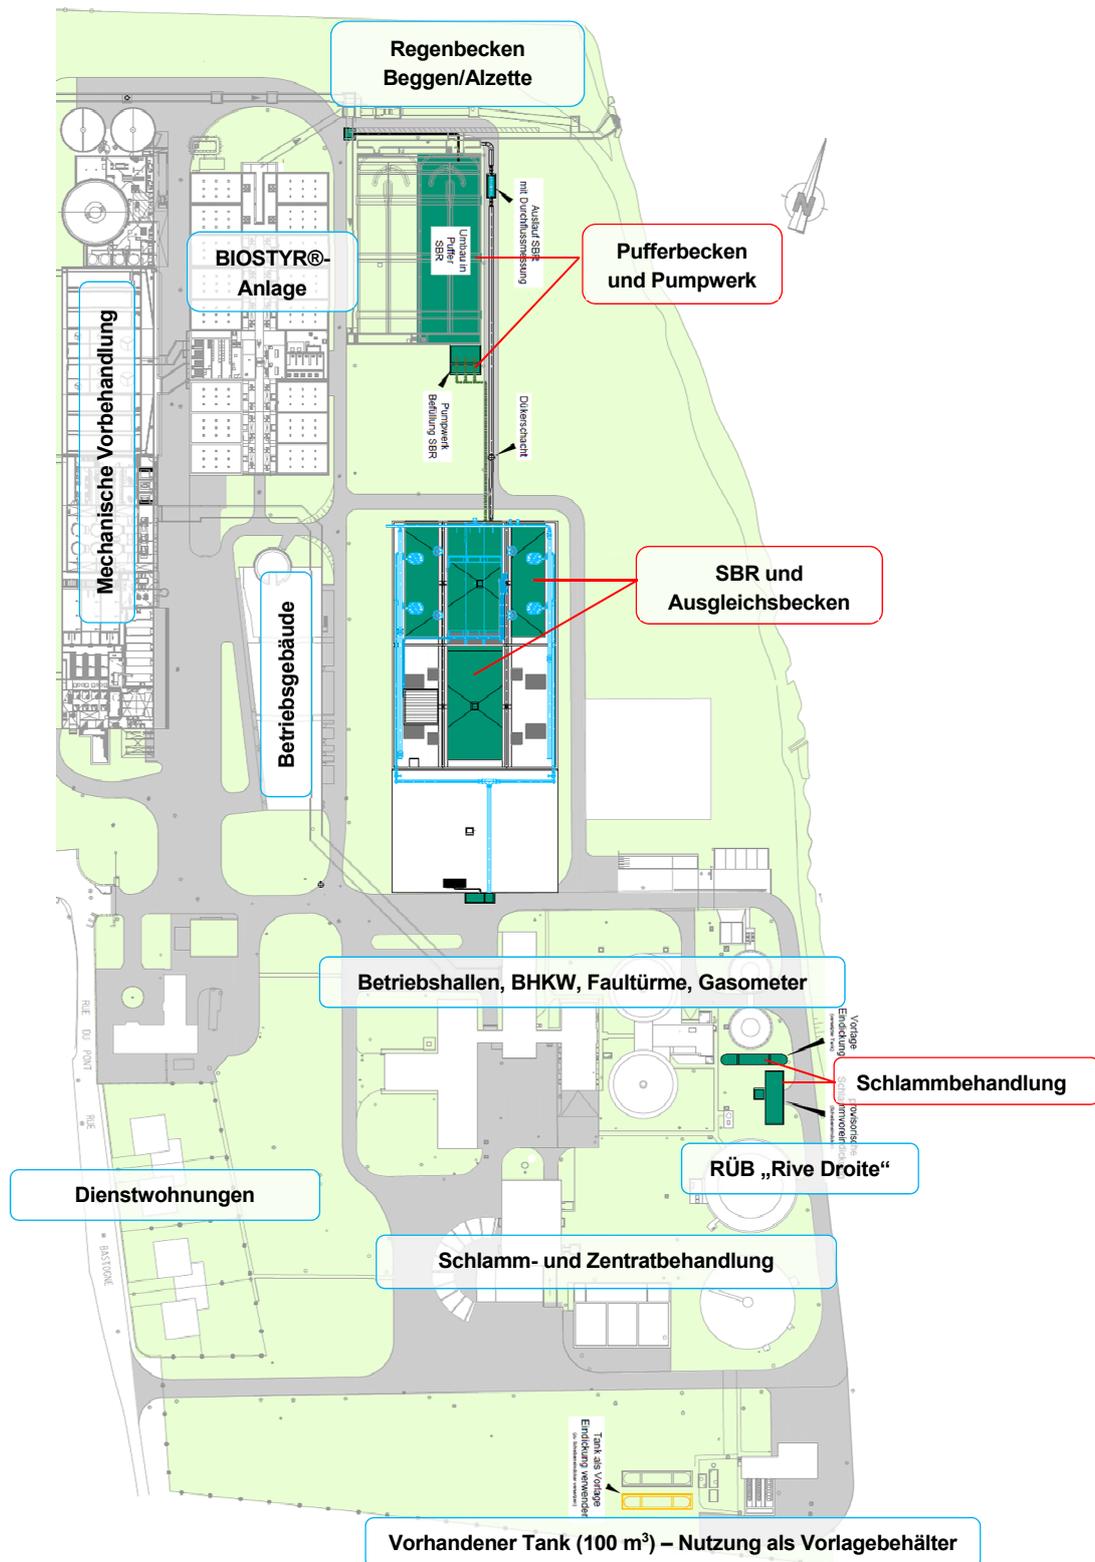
Lage der bestehenden sowie der geplanten Anlagenelemente
